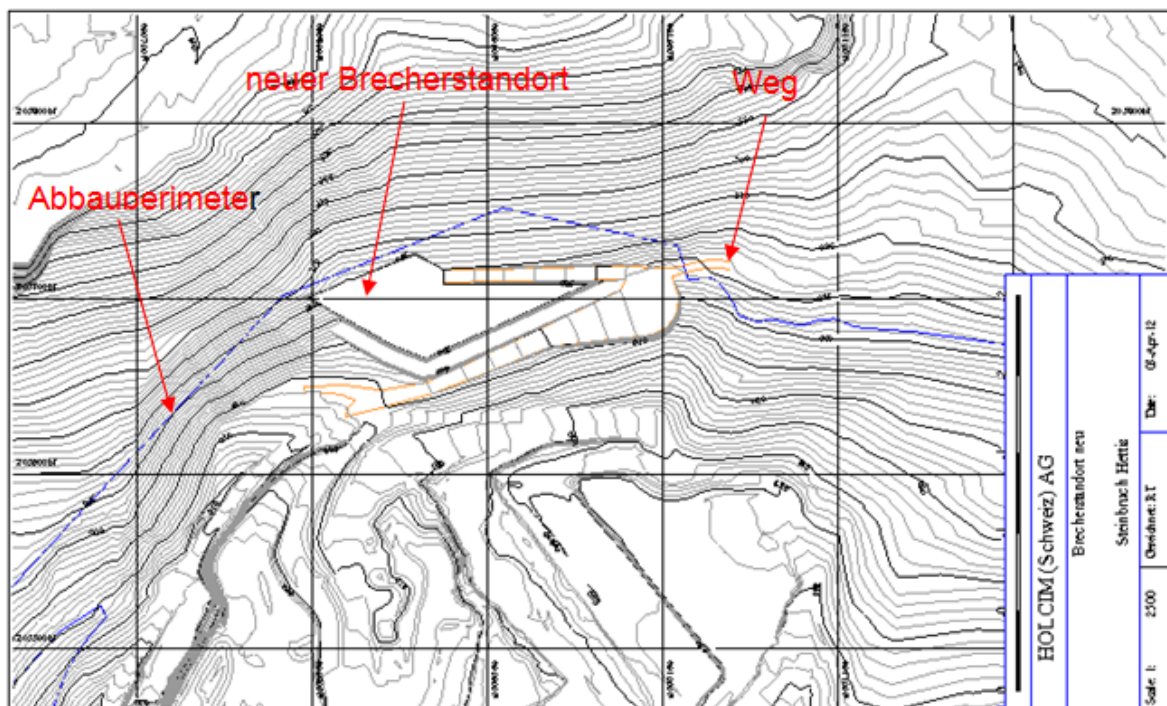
Grundriss neuer Brecherstandort
